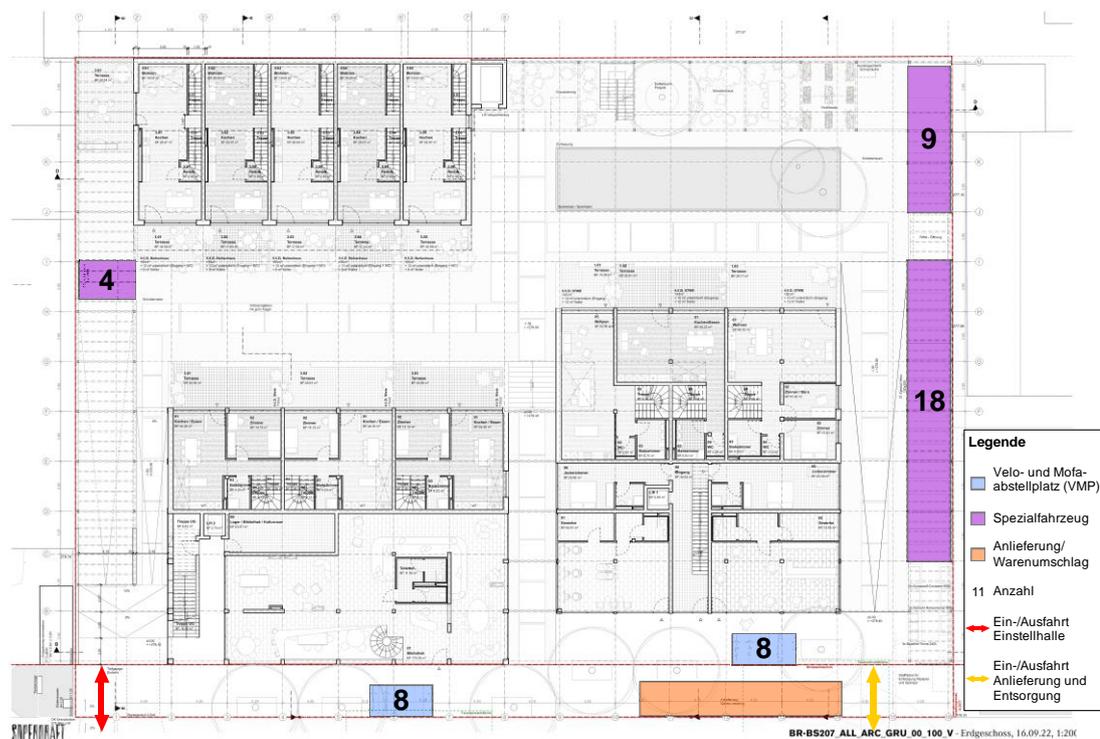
Plan Erdgeschoss mit Abstellplätzen [2]
